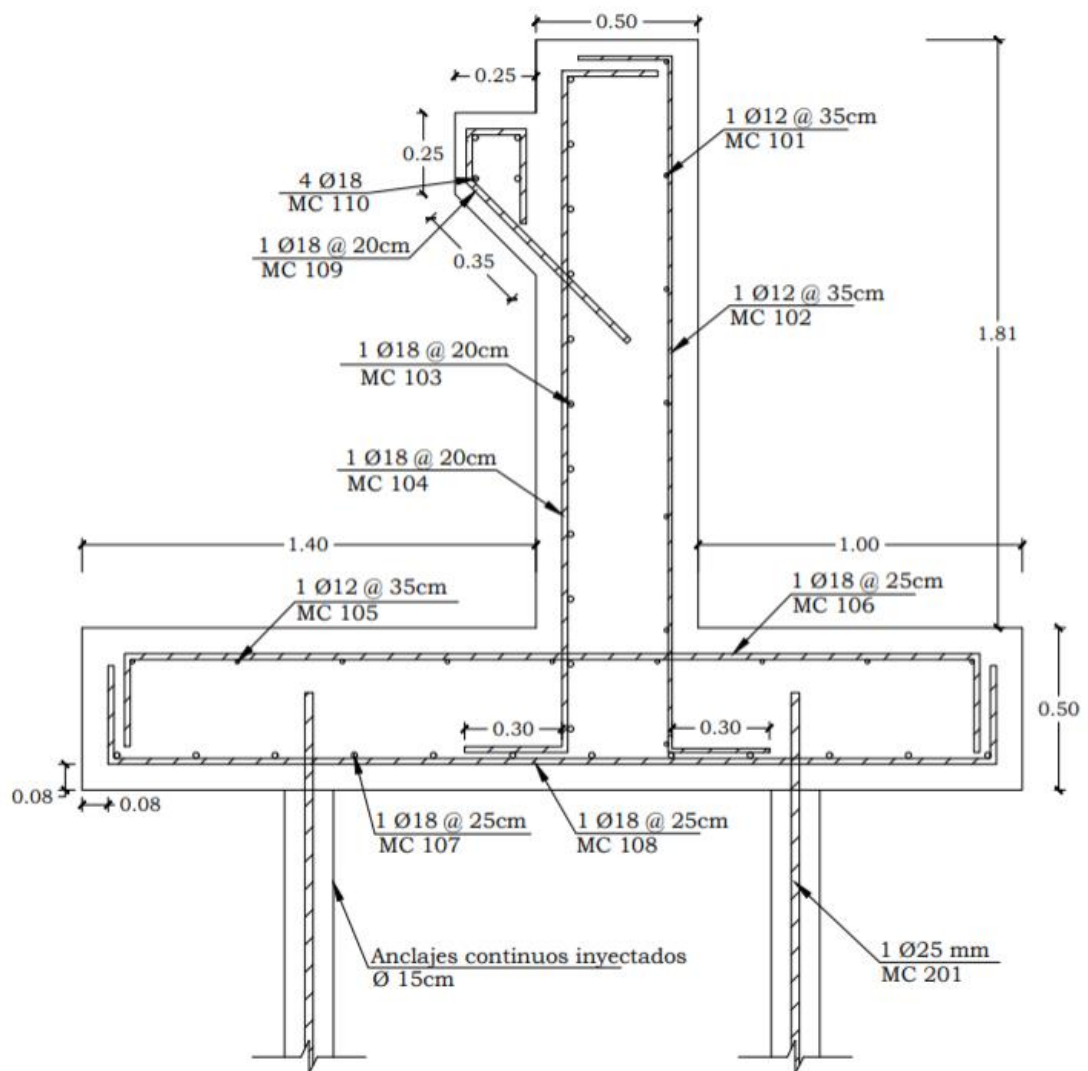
Detalle de acero de refuerzo en el estribo. Fuente: Elaboración propia
